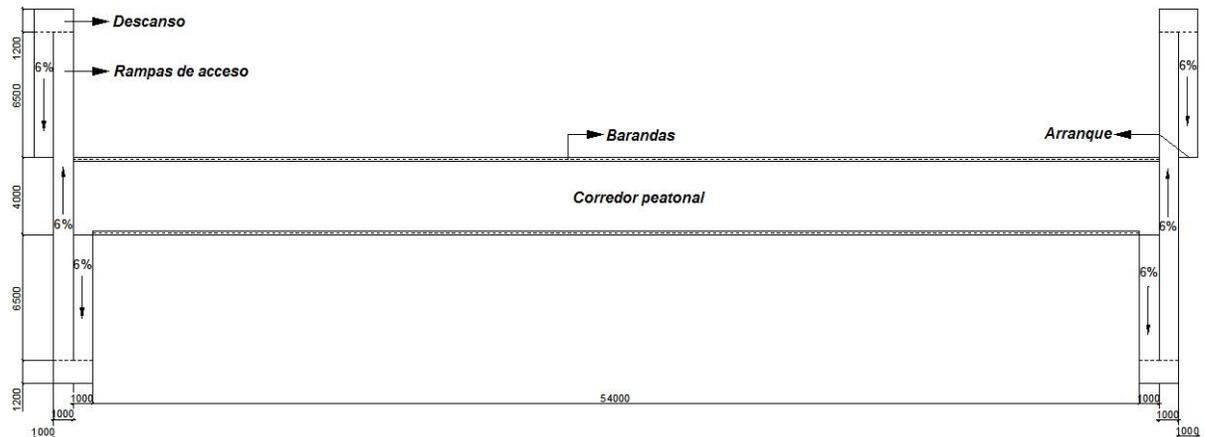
a: Vista en planta del puente peatonal sobre río San Juan.
